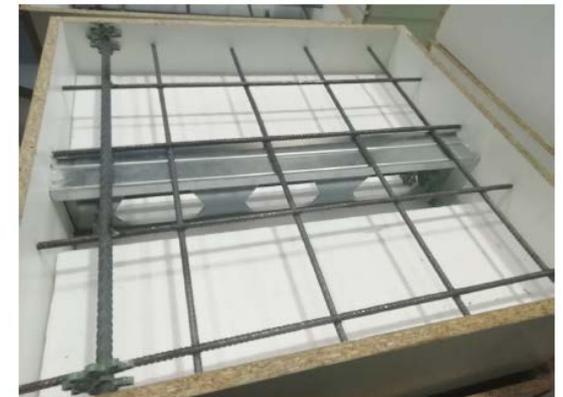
Detalle muestra chapa alveolar previo a hormigonado.
